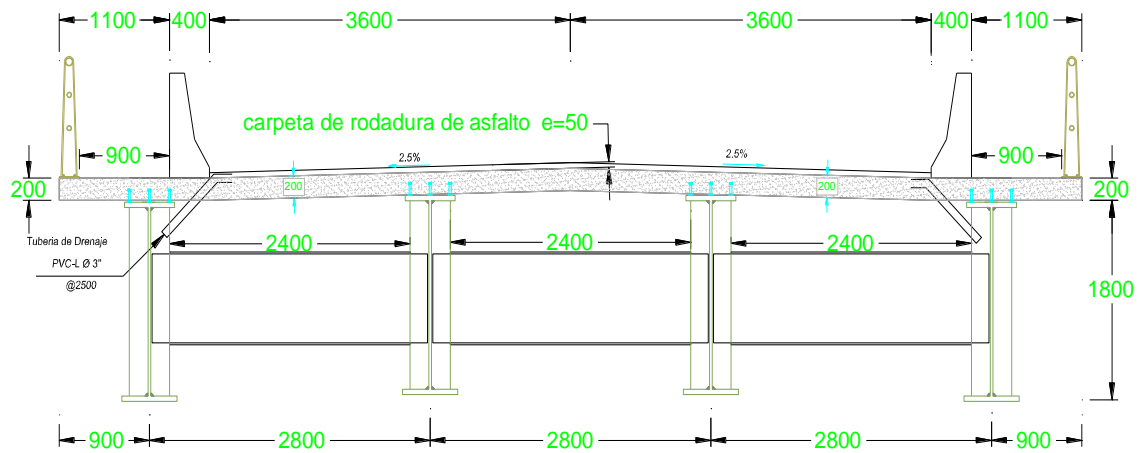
Sección transversal de puente de sección compuesta o mixta
